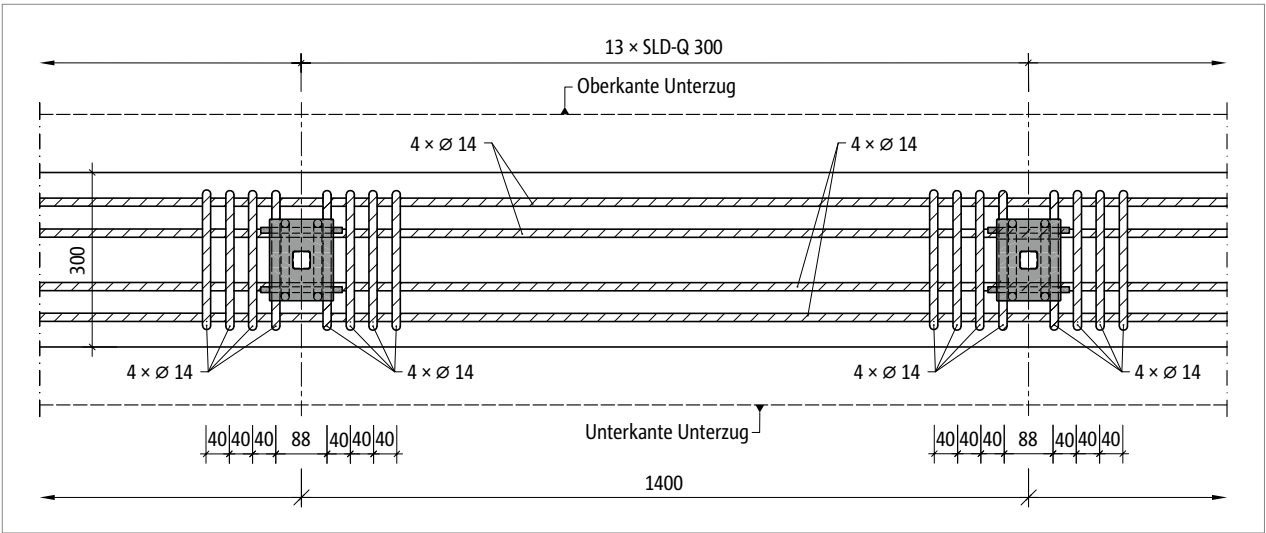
Ansicht der Decke mit Bewehrungsanordnung
